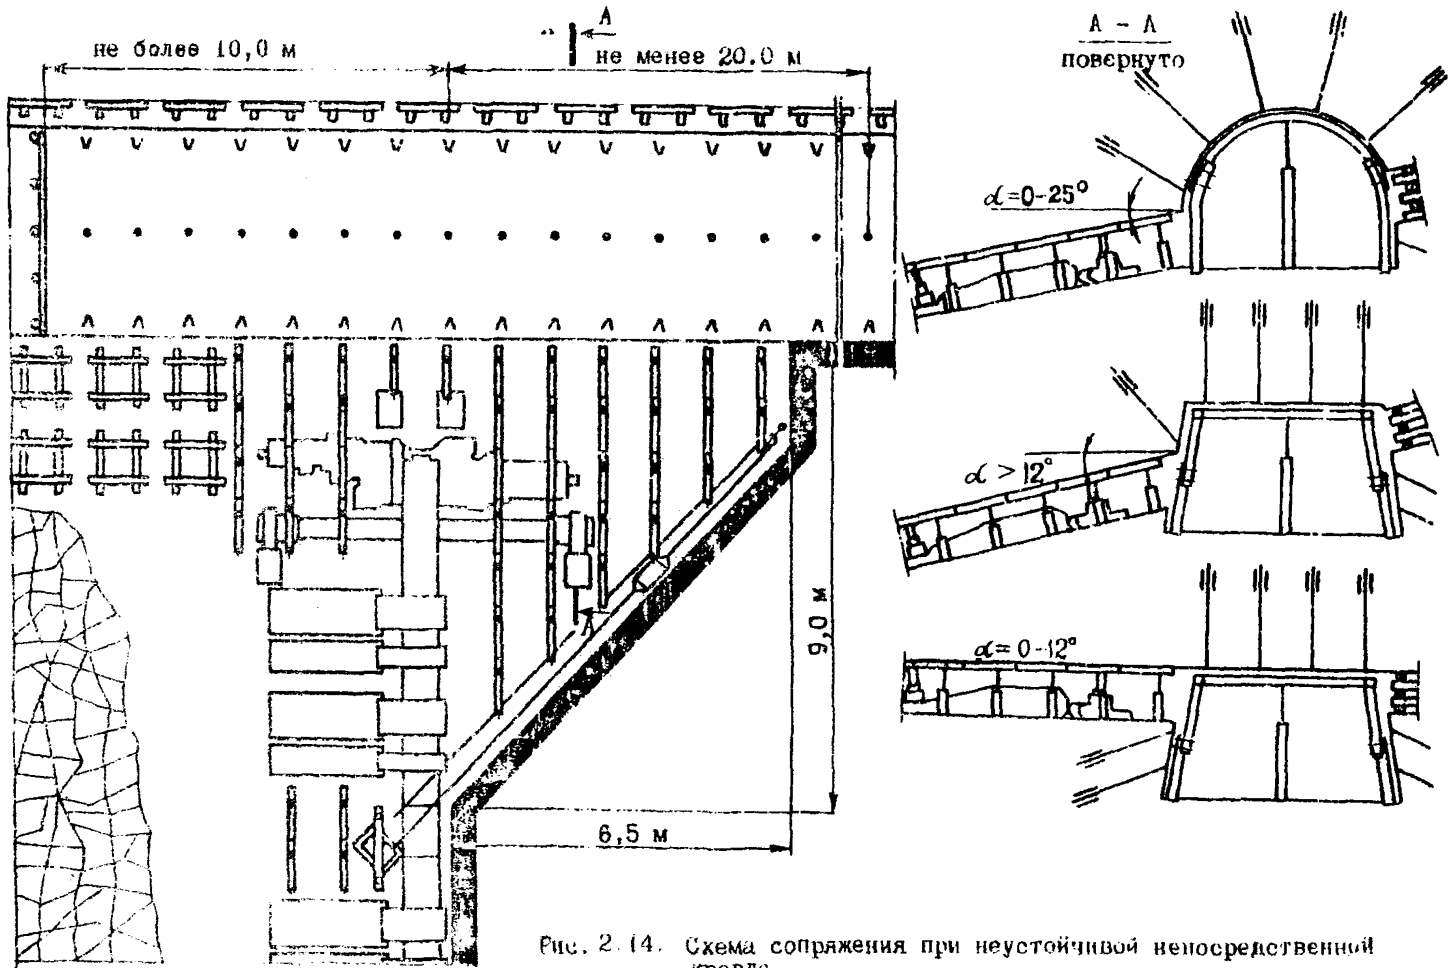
Схема сопряжения при неустойчивой непосредственной кровле
